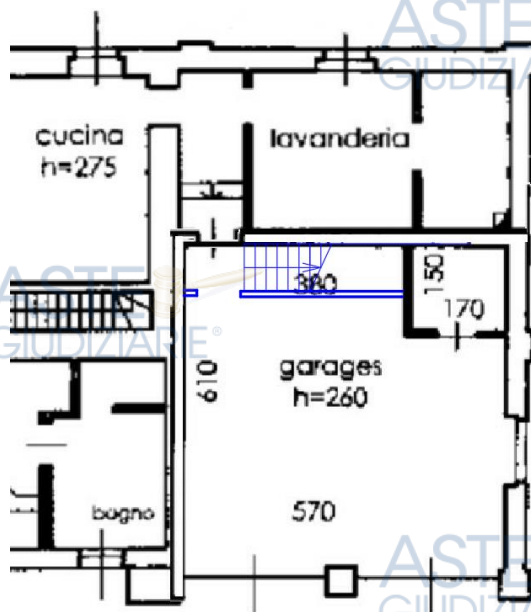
Stralcio planimetrico dell'autorimessa con rappresentata la scala che dal piano terra conduce al primo piano
